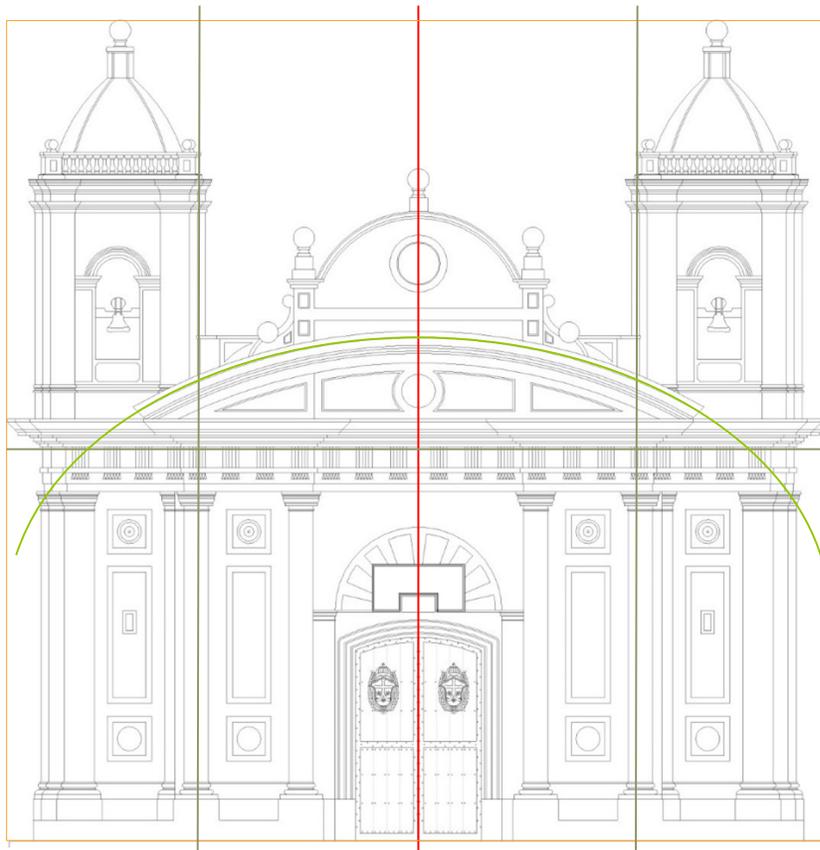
Fachada El Carmen. Sin escala. Elaboración propia.
